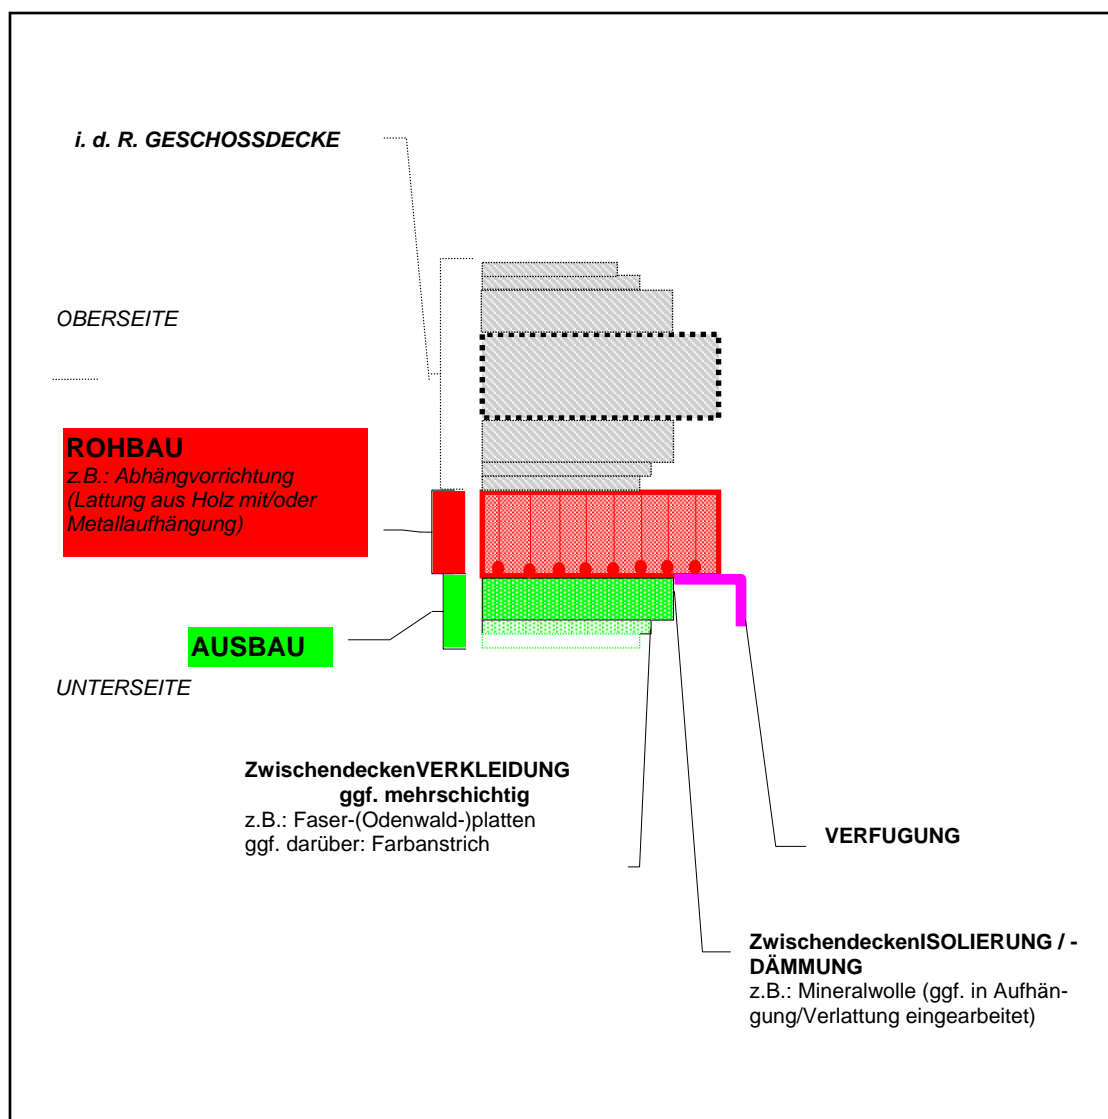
Nomenklatur Rohbau / Ausbau (Spezialfall: Zwischendecke)
